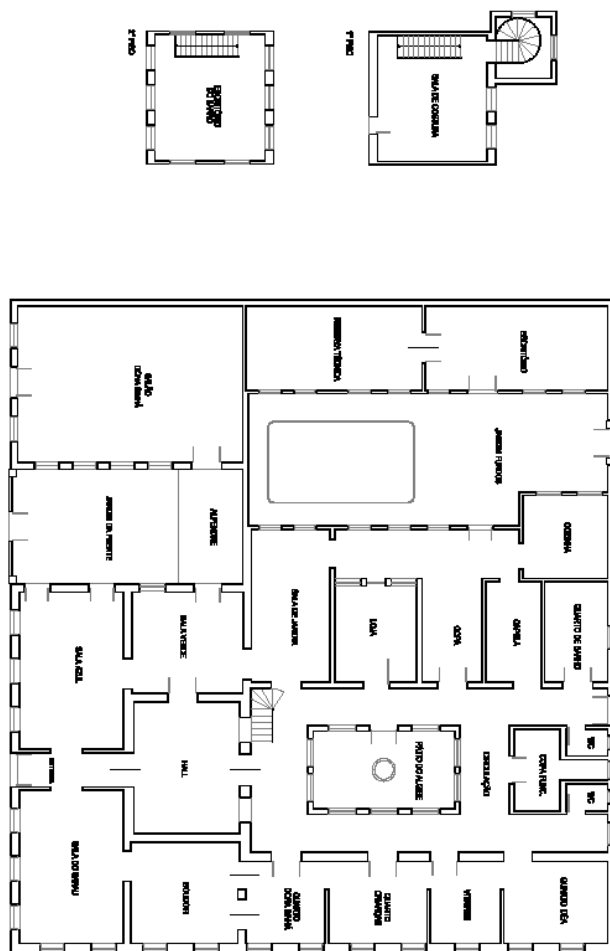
planta baixa dos três pavimentos do Museu da Baronesa. Fonte: arquivo adm. MMPB.
